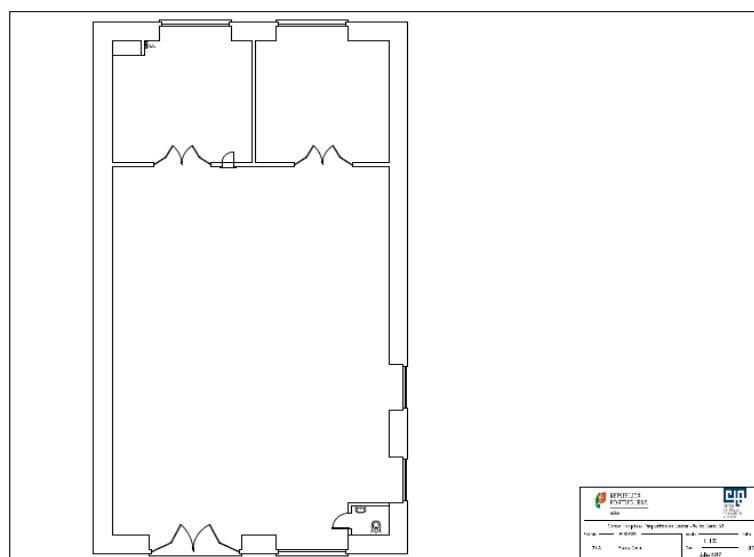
Planta do edifício 31-A. Fonte: Arquivo do C.H.P.L., 2017.
